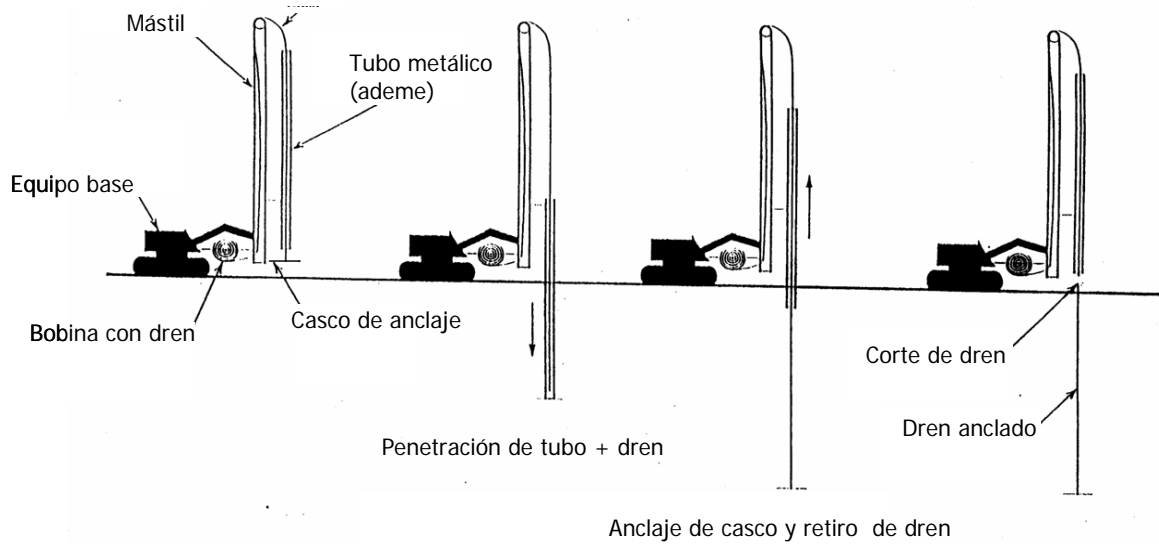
Procedimiento constructivo de los drenes verticales prefabricados.
